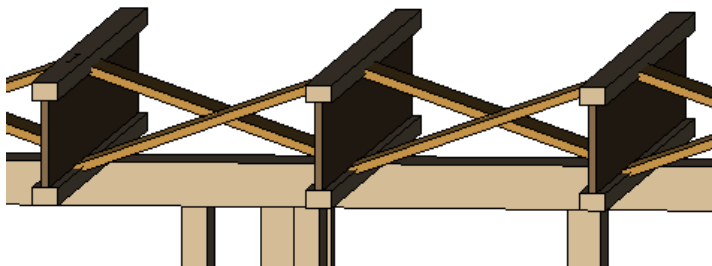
Skladba střešnı́ konstrukce, varianta 3
